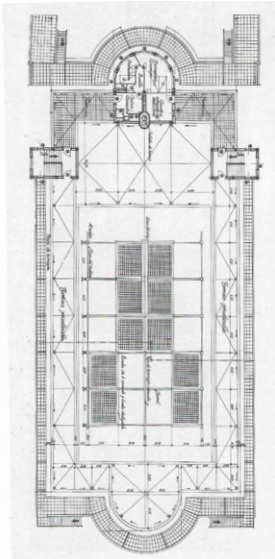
Planta primera publicada en el libro editado por el COAM
